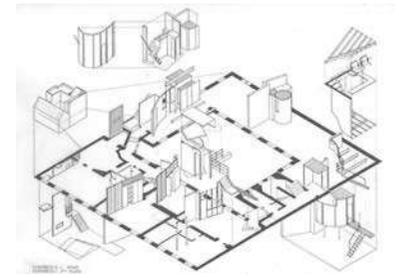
Rüdiger Lainer, potente Elemente im Raum, Grundriss
